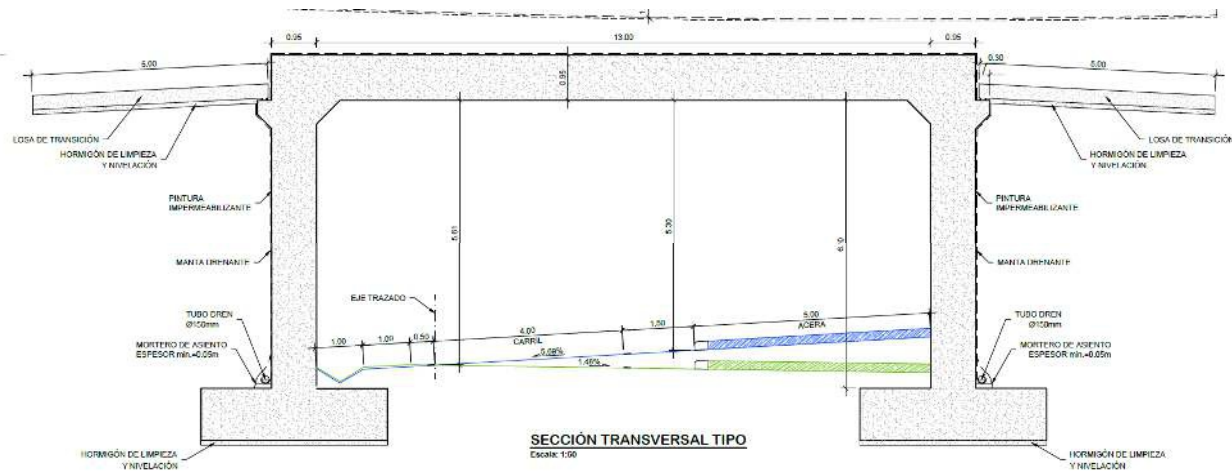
Sección transversal. Estructura E-4. Solución pórtico
